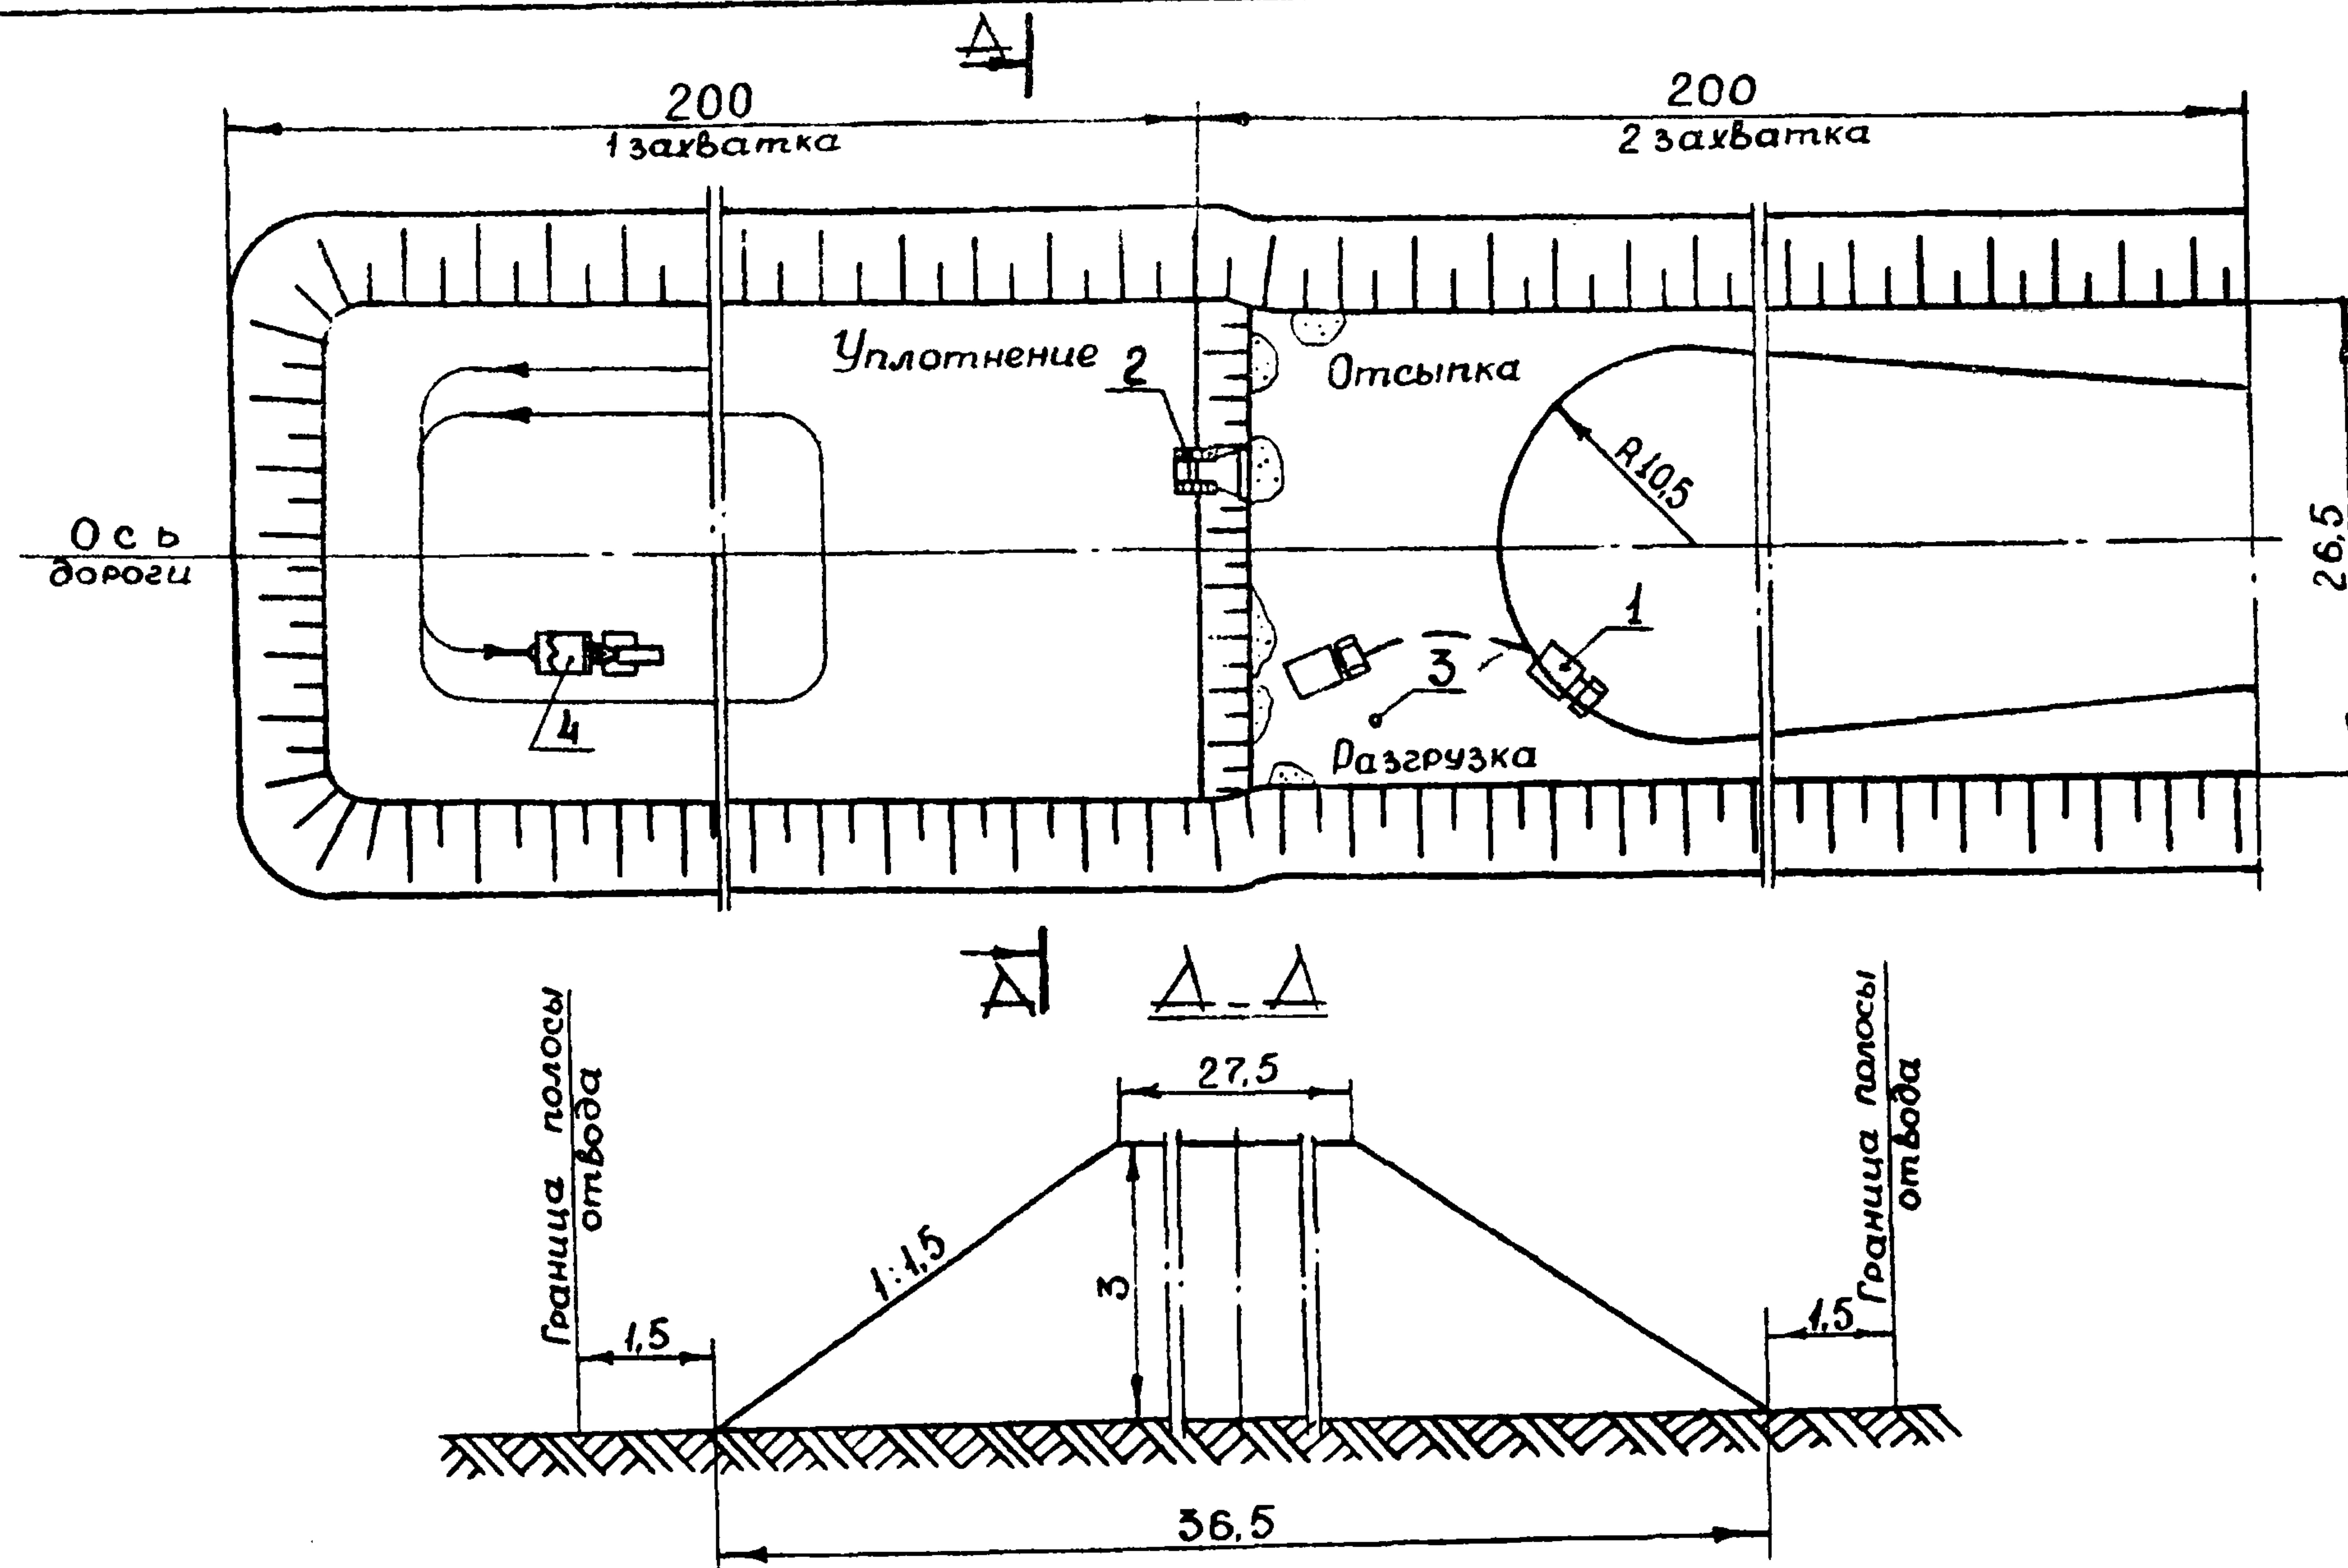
Схема отсыпки грунта при возведении насыпи дорожного полотна.
